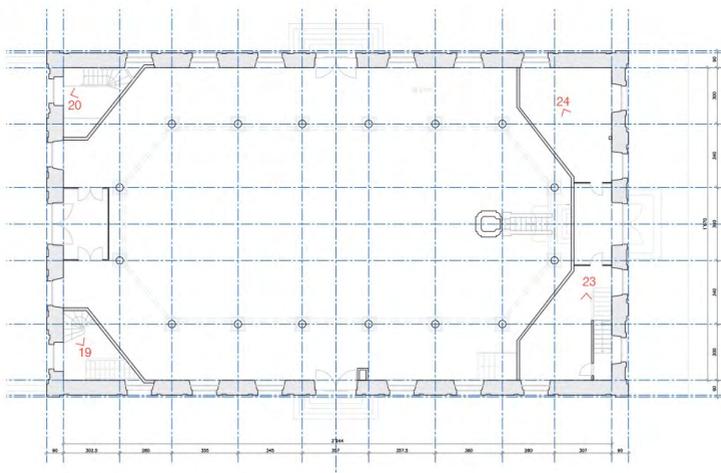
Plan de la mezzanine. Atelier Féroé 2017.
